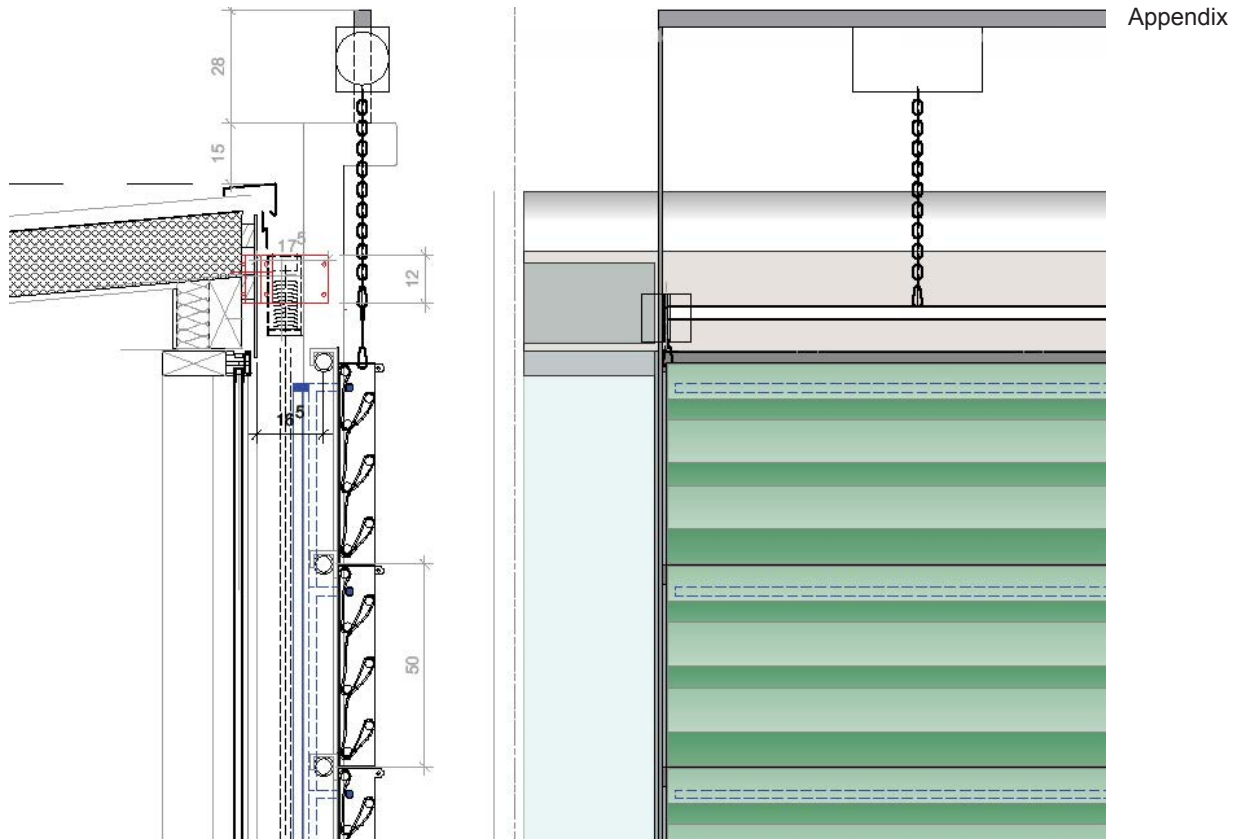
Rednitzhembach, Technikum/ Fassadenversuchsstand – Traufdetail (o. M.) (THN-AR)
